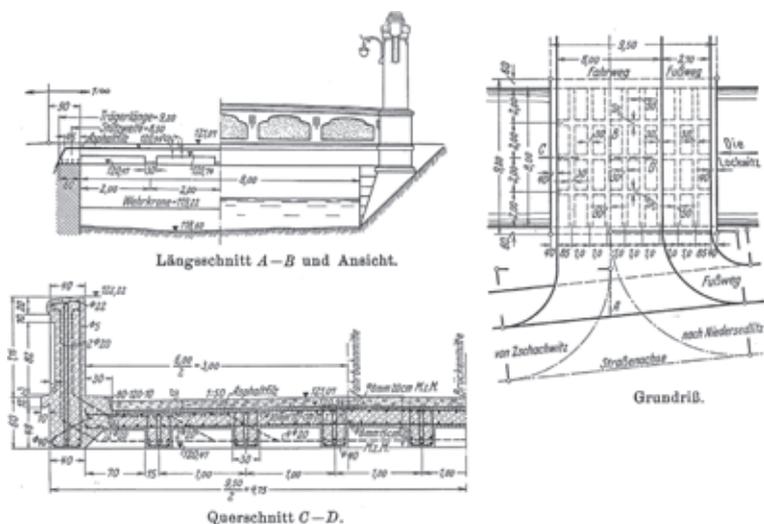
Brücke Fabrikzufahrt Dresden/Niedersedlitz – Grundriss und Schnitte [10]
